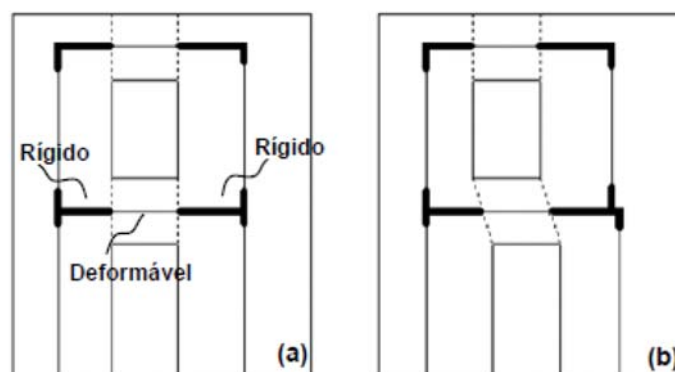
Definição do comprimento efetivo das vigas quando as aberturas em pisos consecutivos são alinhadas (a) ou desalinhadas (b) (Pereira, 2009)
